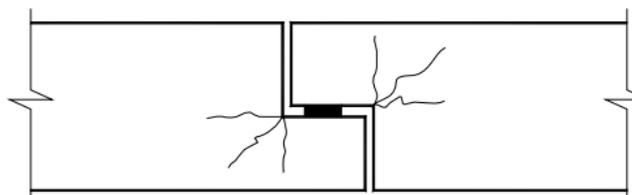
Fissura por ruptura frágil em apoios externos mal posicionados
